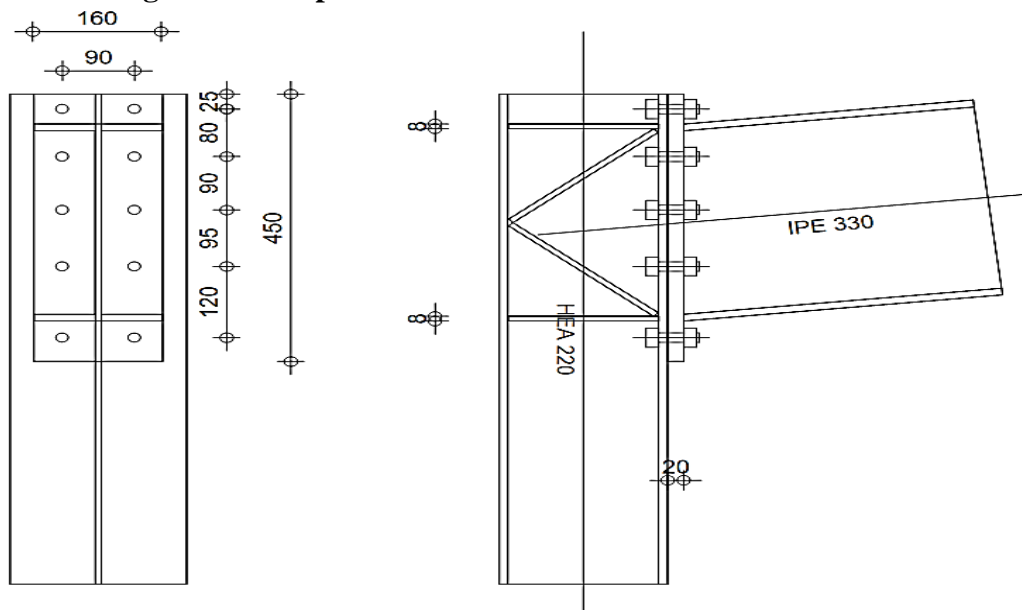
Disposition des boulons Traverse-poteaux
